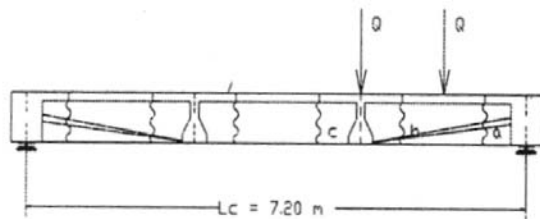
Ensayo de viga con sección cajón DC2. [ANLLÓ (1996)]
